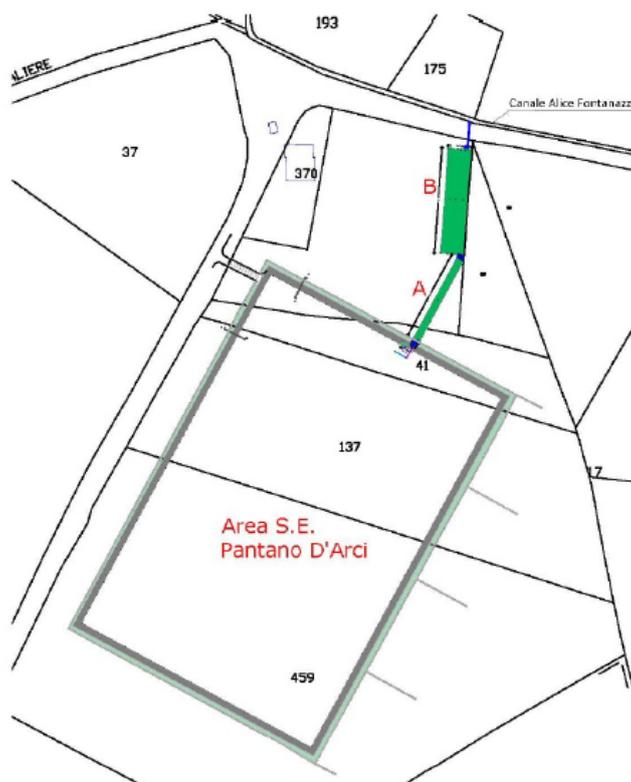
Schema planimetrico con individuazione delle vasche di laminazione A e B
